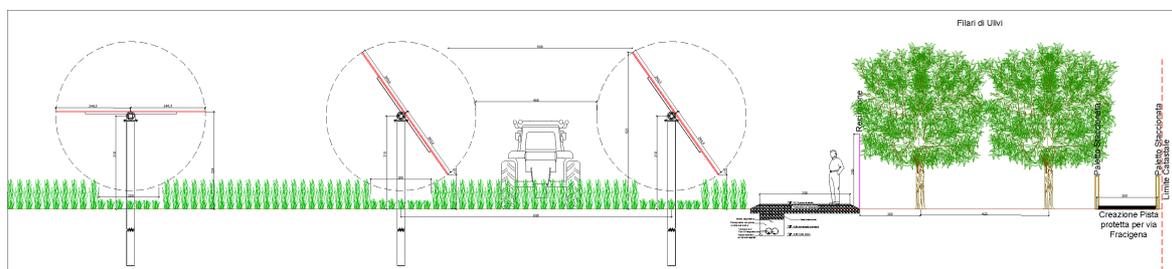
Sezione tipo dell'Impianto Agrovoltaico PIANETTI
